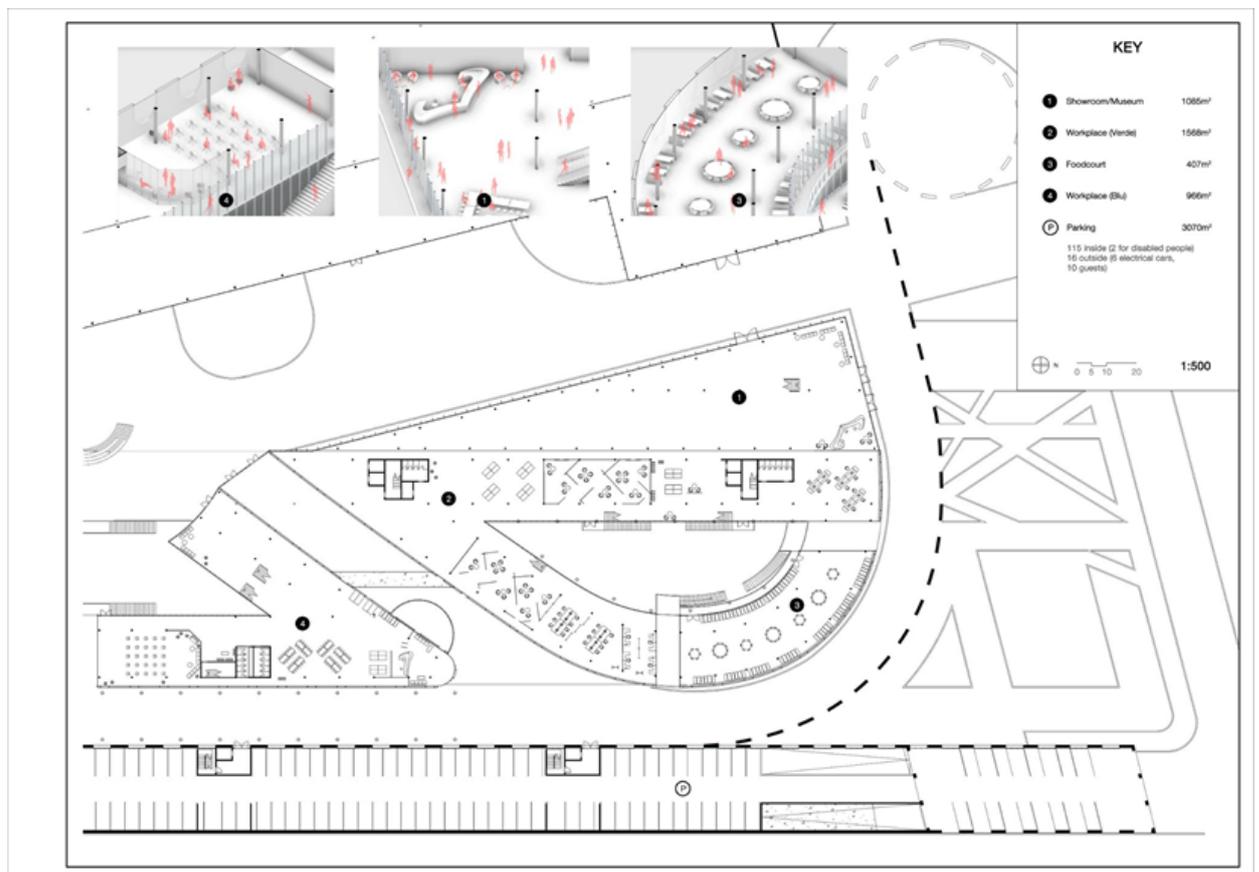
Детальный план 1-го этажа (чертеж автора)
